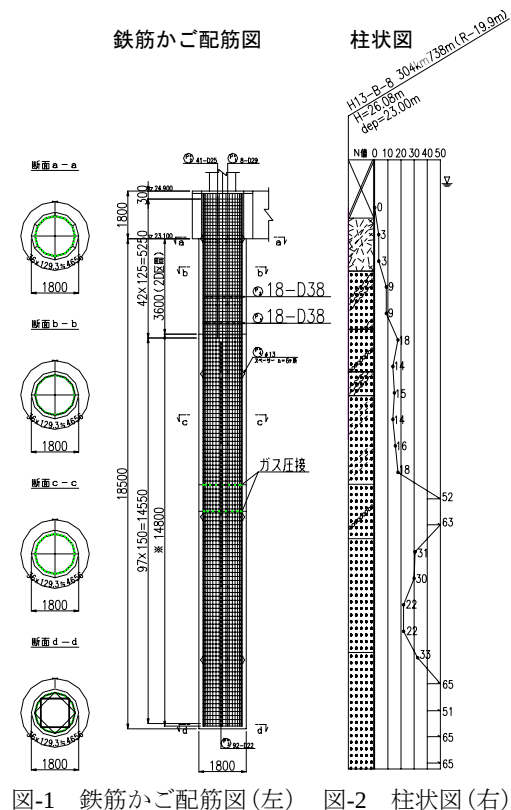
鉄筋かご配筋図(左) 図-2 柱状図(右)
